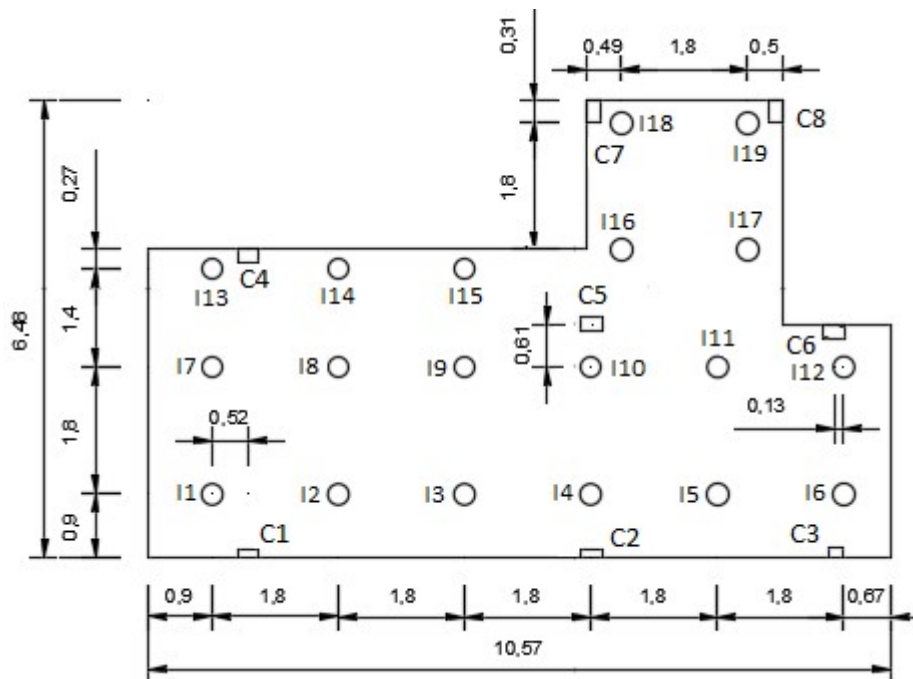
Detalhe em planta do espaçamento entre inclusões.
